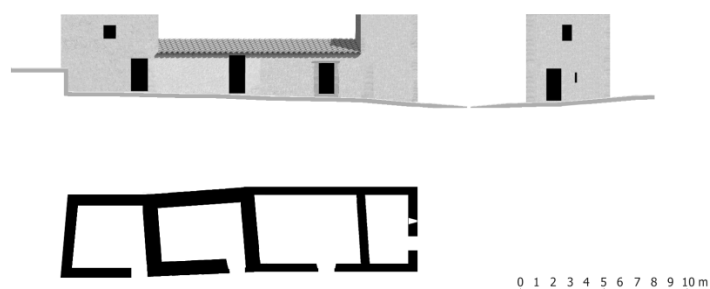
Alzados y planta de las algarfas de *Son Nadal*. Fase 4.
